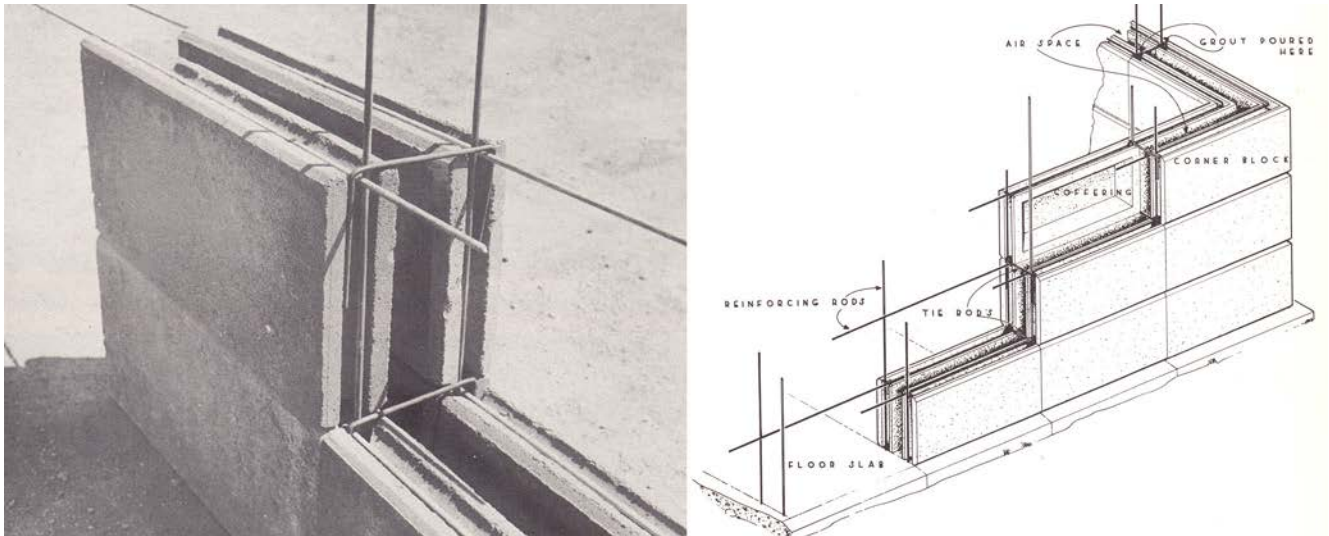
Fotografía de bloque textil de hormigón (Helen Levitt) y sistema de construcción textil con bloque de hormigón (David Dodge).
